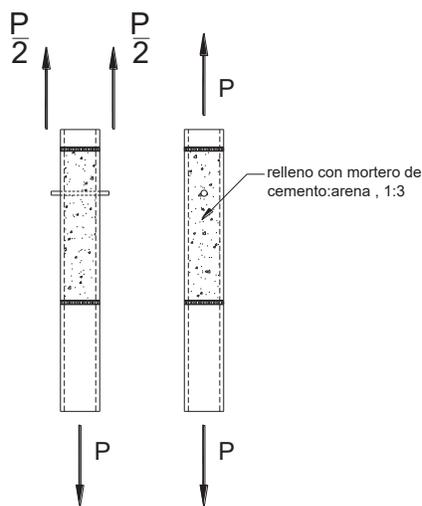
Unión de bambú con cargas a tensión paralelas a la fibra, tipo P.
